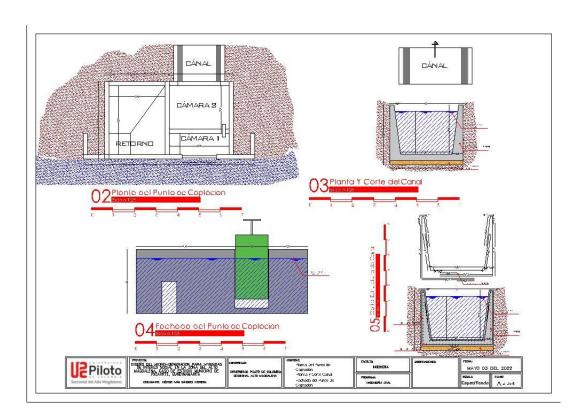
Plano A2-4, Planta del Punto de Captación y Planta de la Canal.
